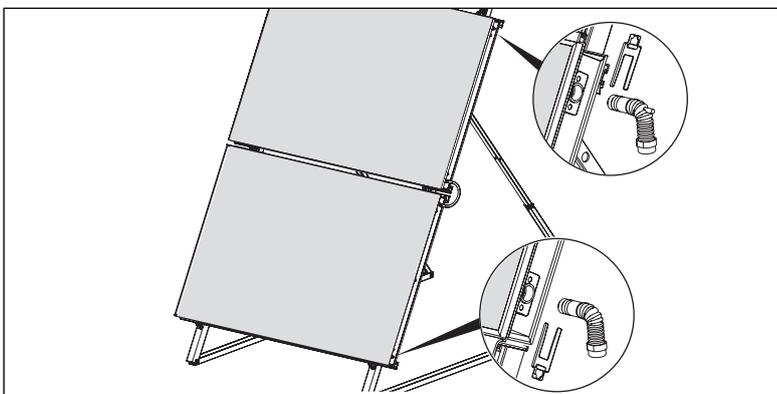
Collegamento idraulico VFK 150 H disposizione sovrapposta del campo
